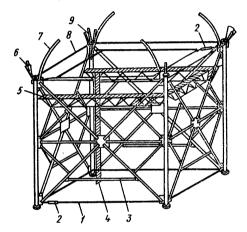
Схема разбивки конструкции башин на монтажные блоки
